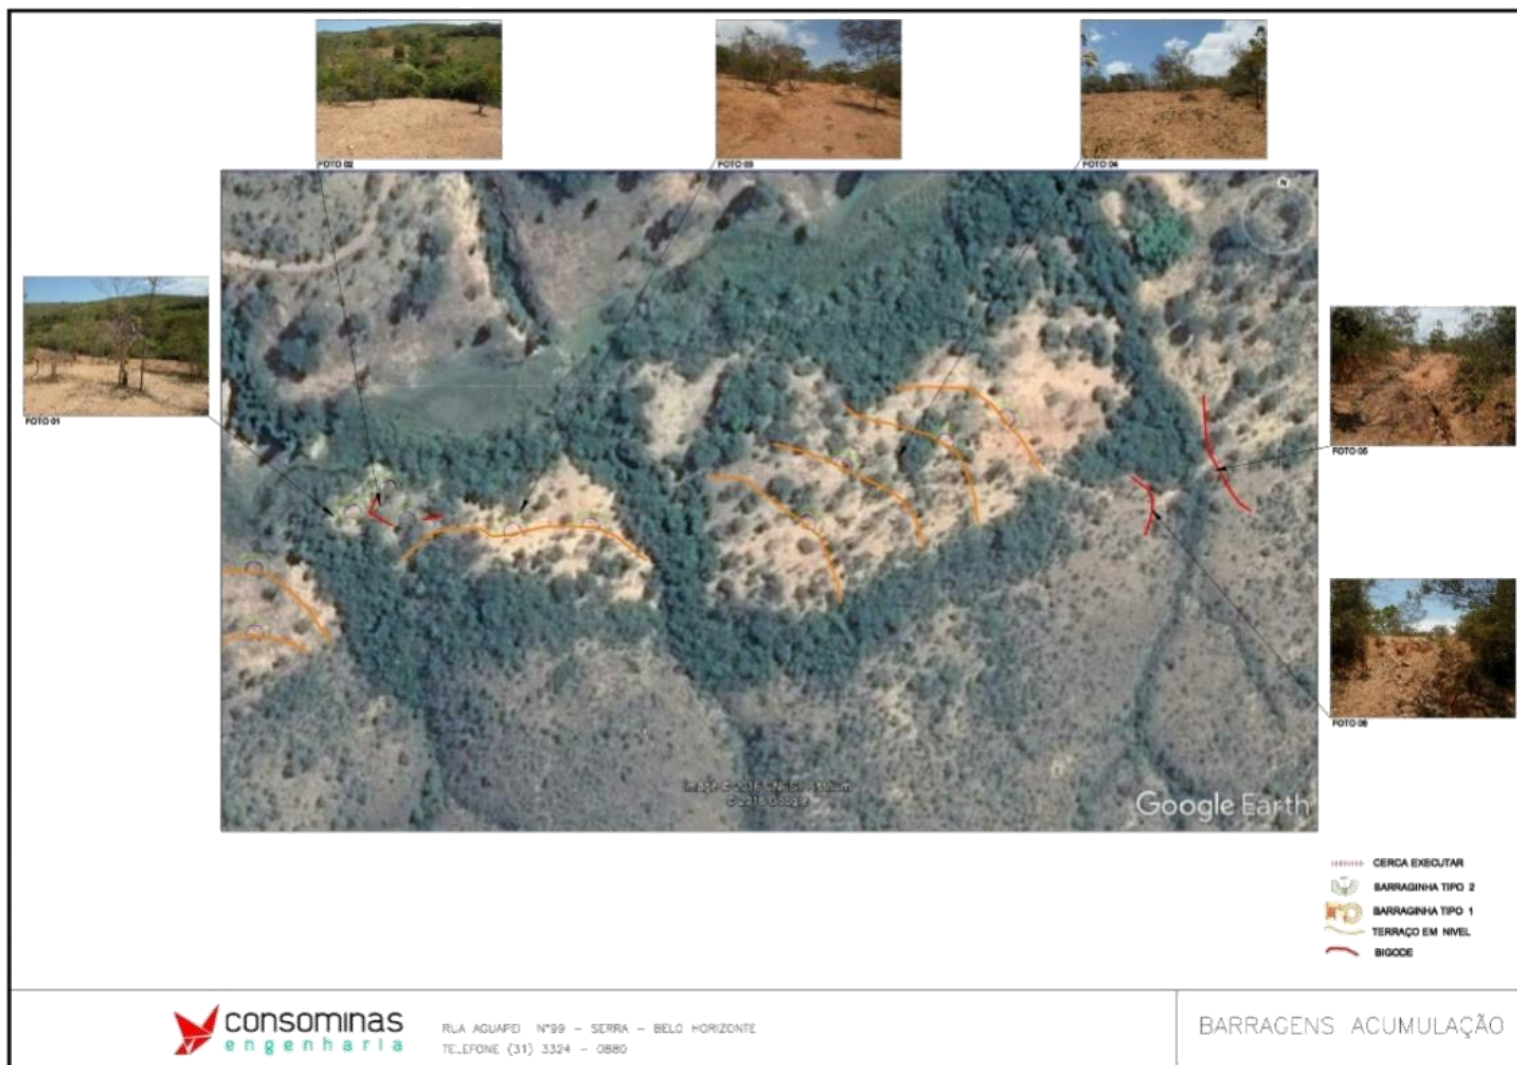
Croqui 02 – Complexo de ações – Área 4
